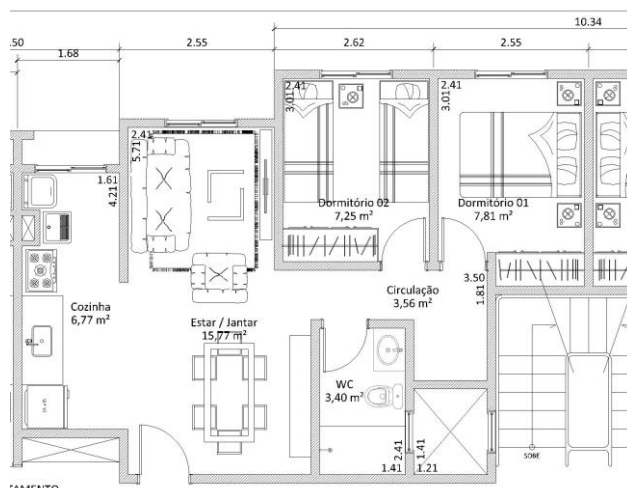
Apartamento tipo 2 - Projeto 2. Fonte: RDB Construtora.
